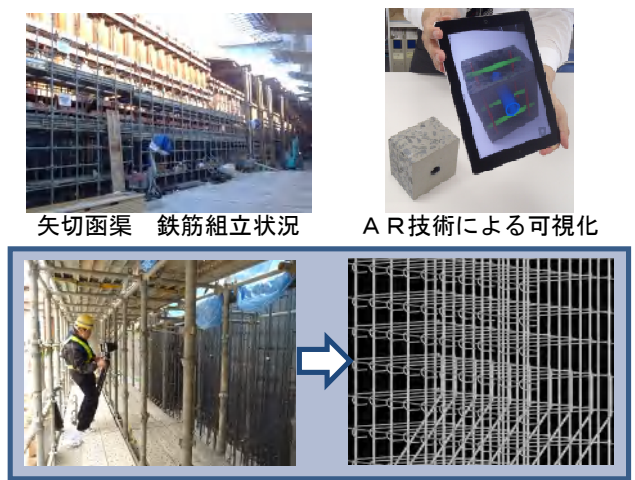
写真計測による鉄筋のモデル化とA Rによる可視化の試行
